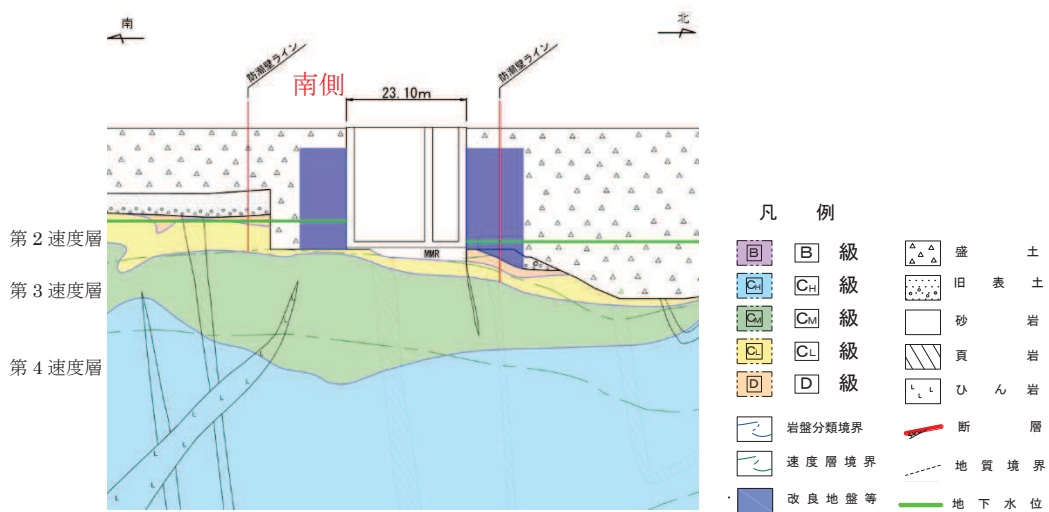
第3号機放水立坑地質断面図 (B-B断面)
